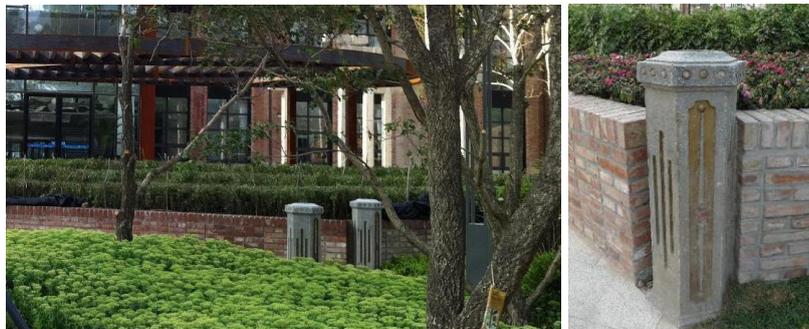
Бетонные столбы главной внутренней лестницы офисного здания, использованные в качестве торцевых элементов ограждения садовой дорожки
